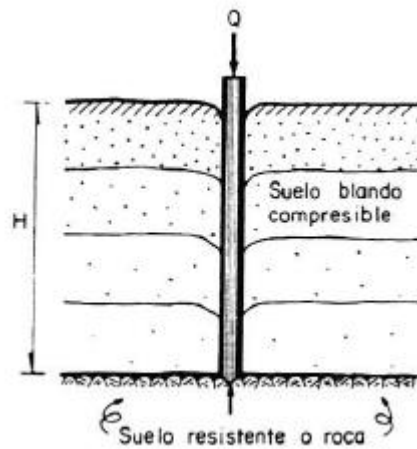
Pilotes de punta, Manual de diseño y construcción de pilas y pilotes, SMMS, 1983.
